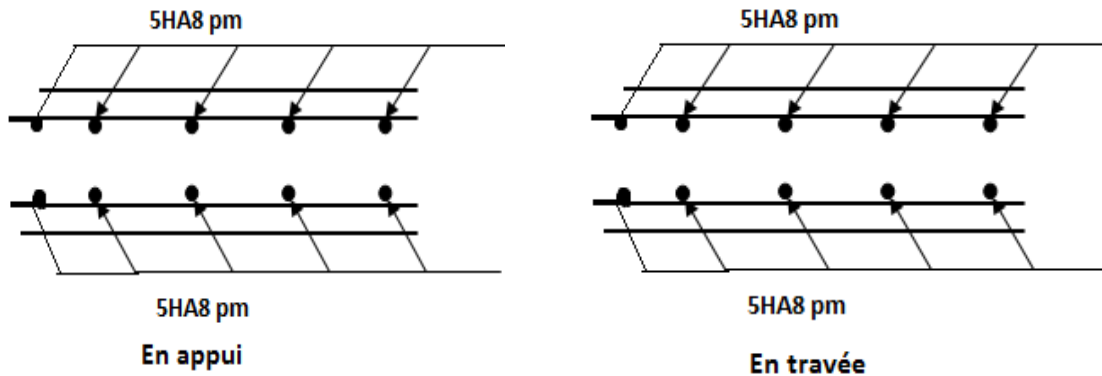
Schéma de ferrailage de la dalle du local machine
